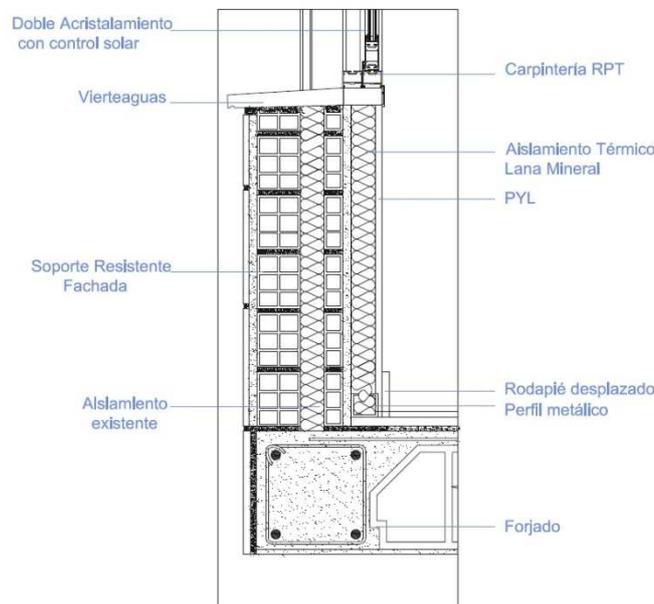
Aislamiento fachada por el interior, Autoportante. (Fuente Propia)
